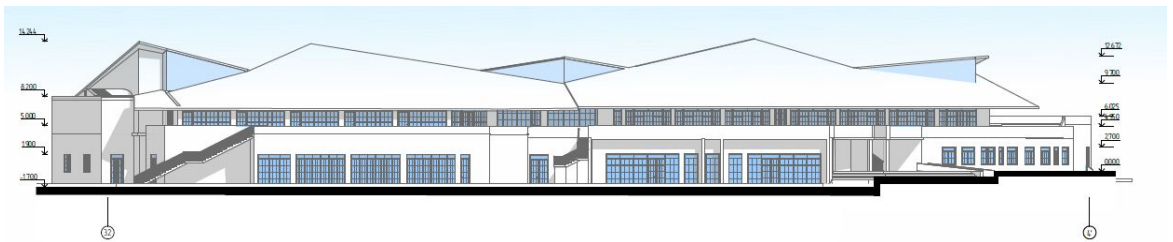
Фасад задньої сторони будівлі зі сторони басейну
